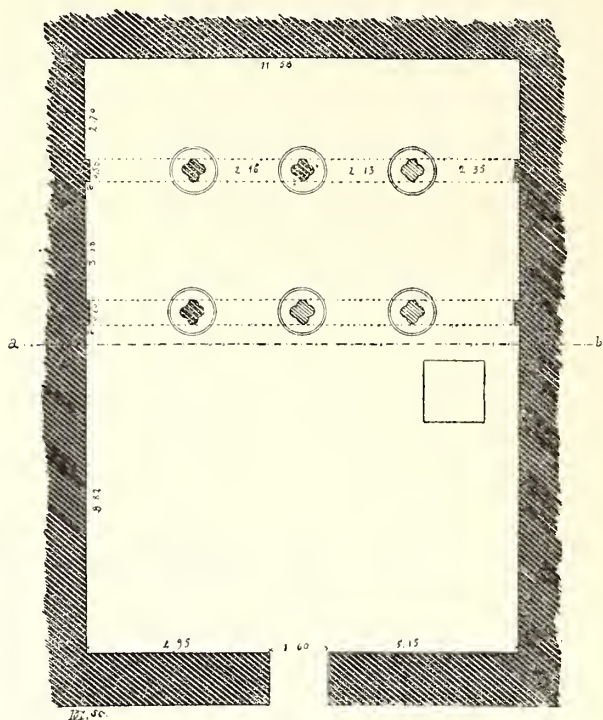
Beni Hassan. 7^e tombeau. Plan.
